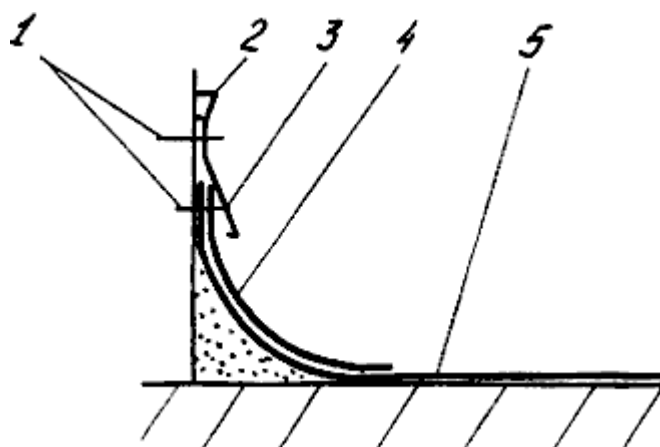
Крепление основного и дополнительного слоев к вертикальным конструкциям:
